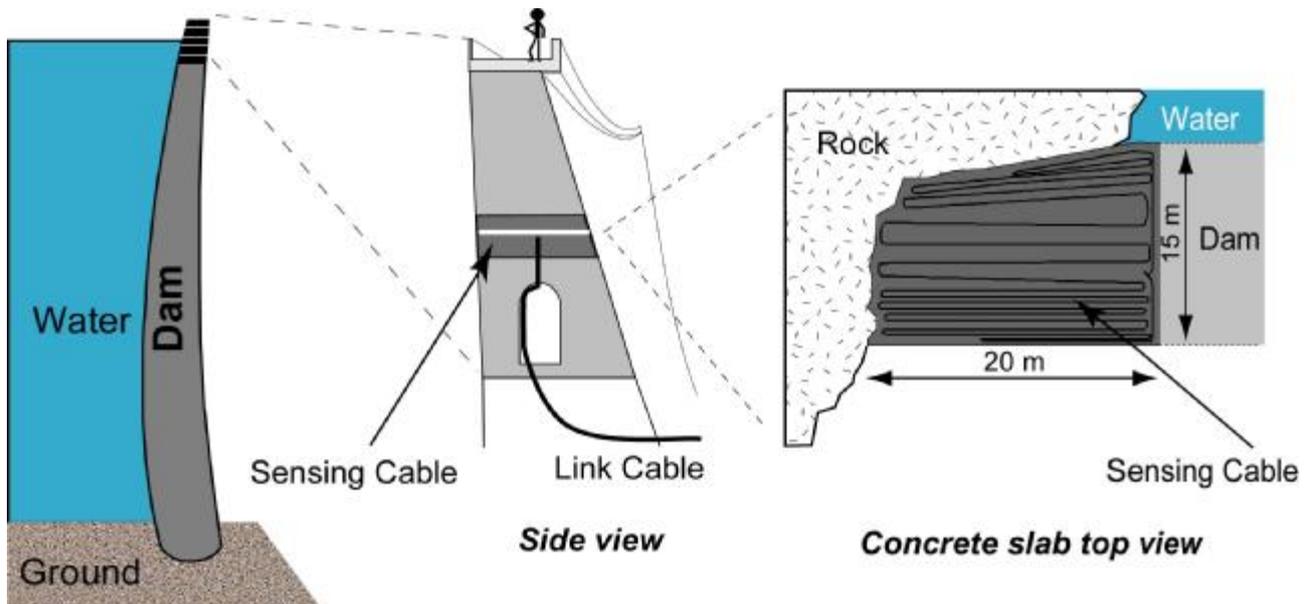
Installation dans un bloc de béton d'un barrage voûte (Source MET-EPFL, Omnisens, SMART-TEC).
